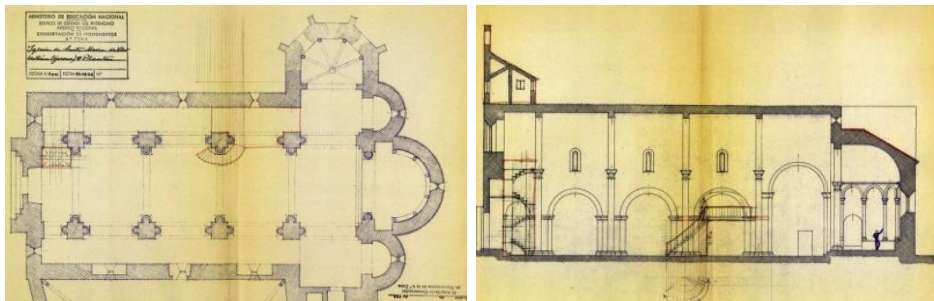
Vilabertran. Monasterio de Santa María AAFV. Planta y sección longitudinal. Planos de proyecto. Alejandro Ferrant
